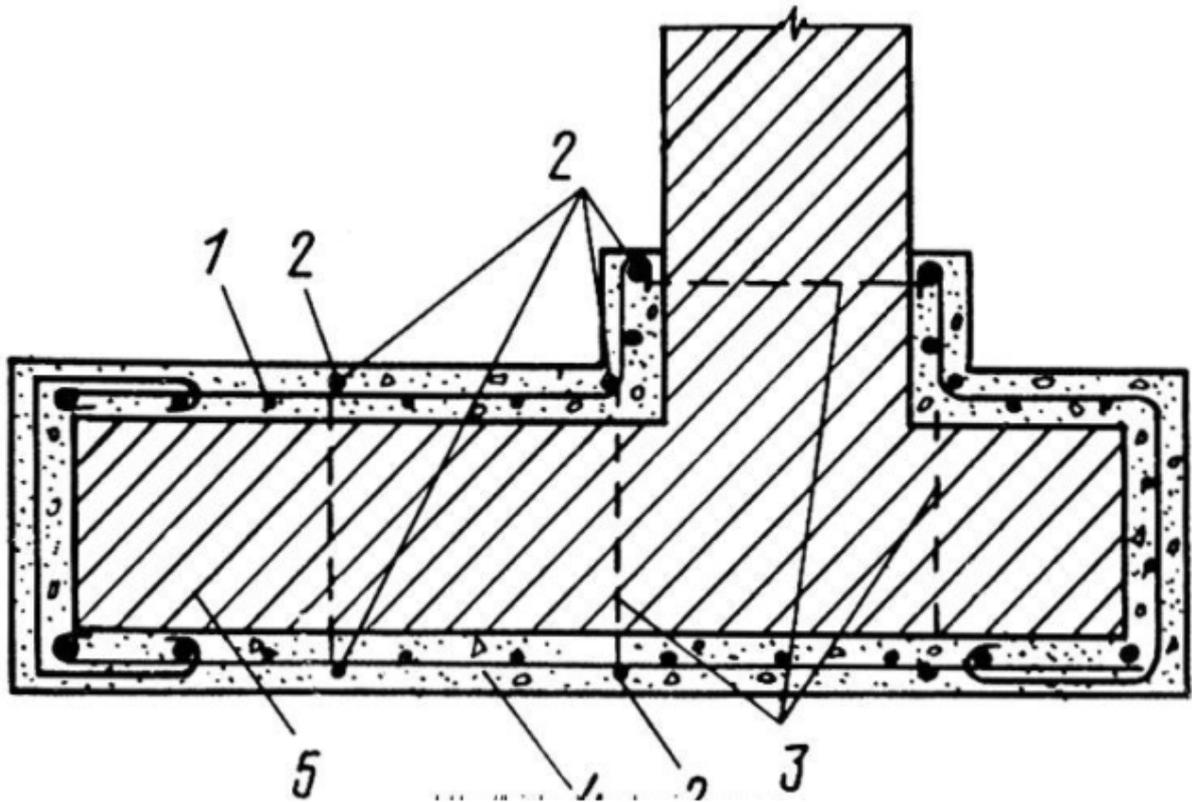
Схема підсилення існуючого фундаменту залізобетонною обіймою з анкеруванням (поперечний розріз)
